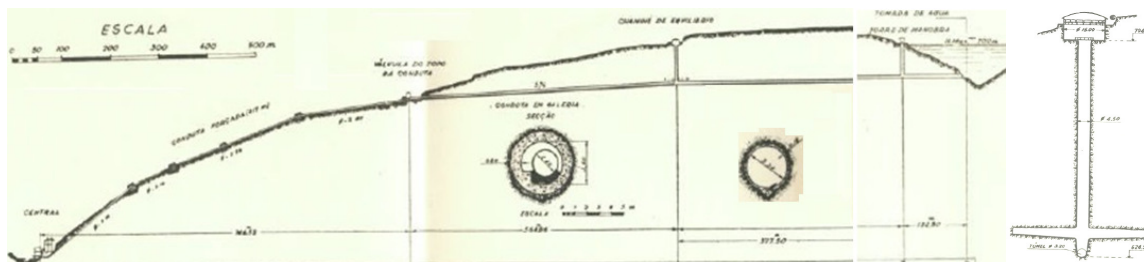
Perfil longitudinal e CE do AH de Venda Nova, [5].
